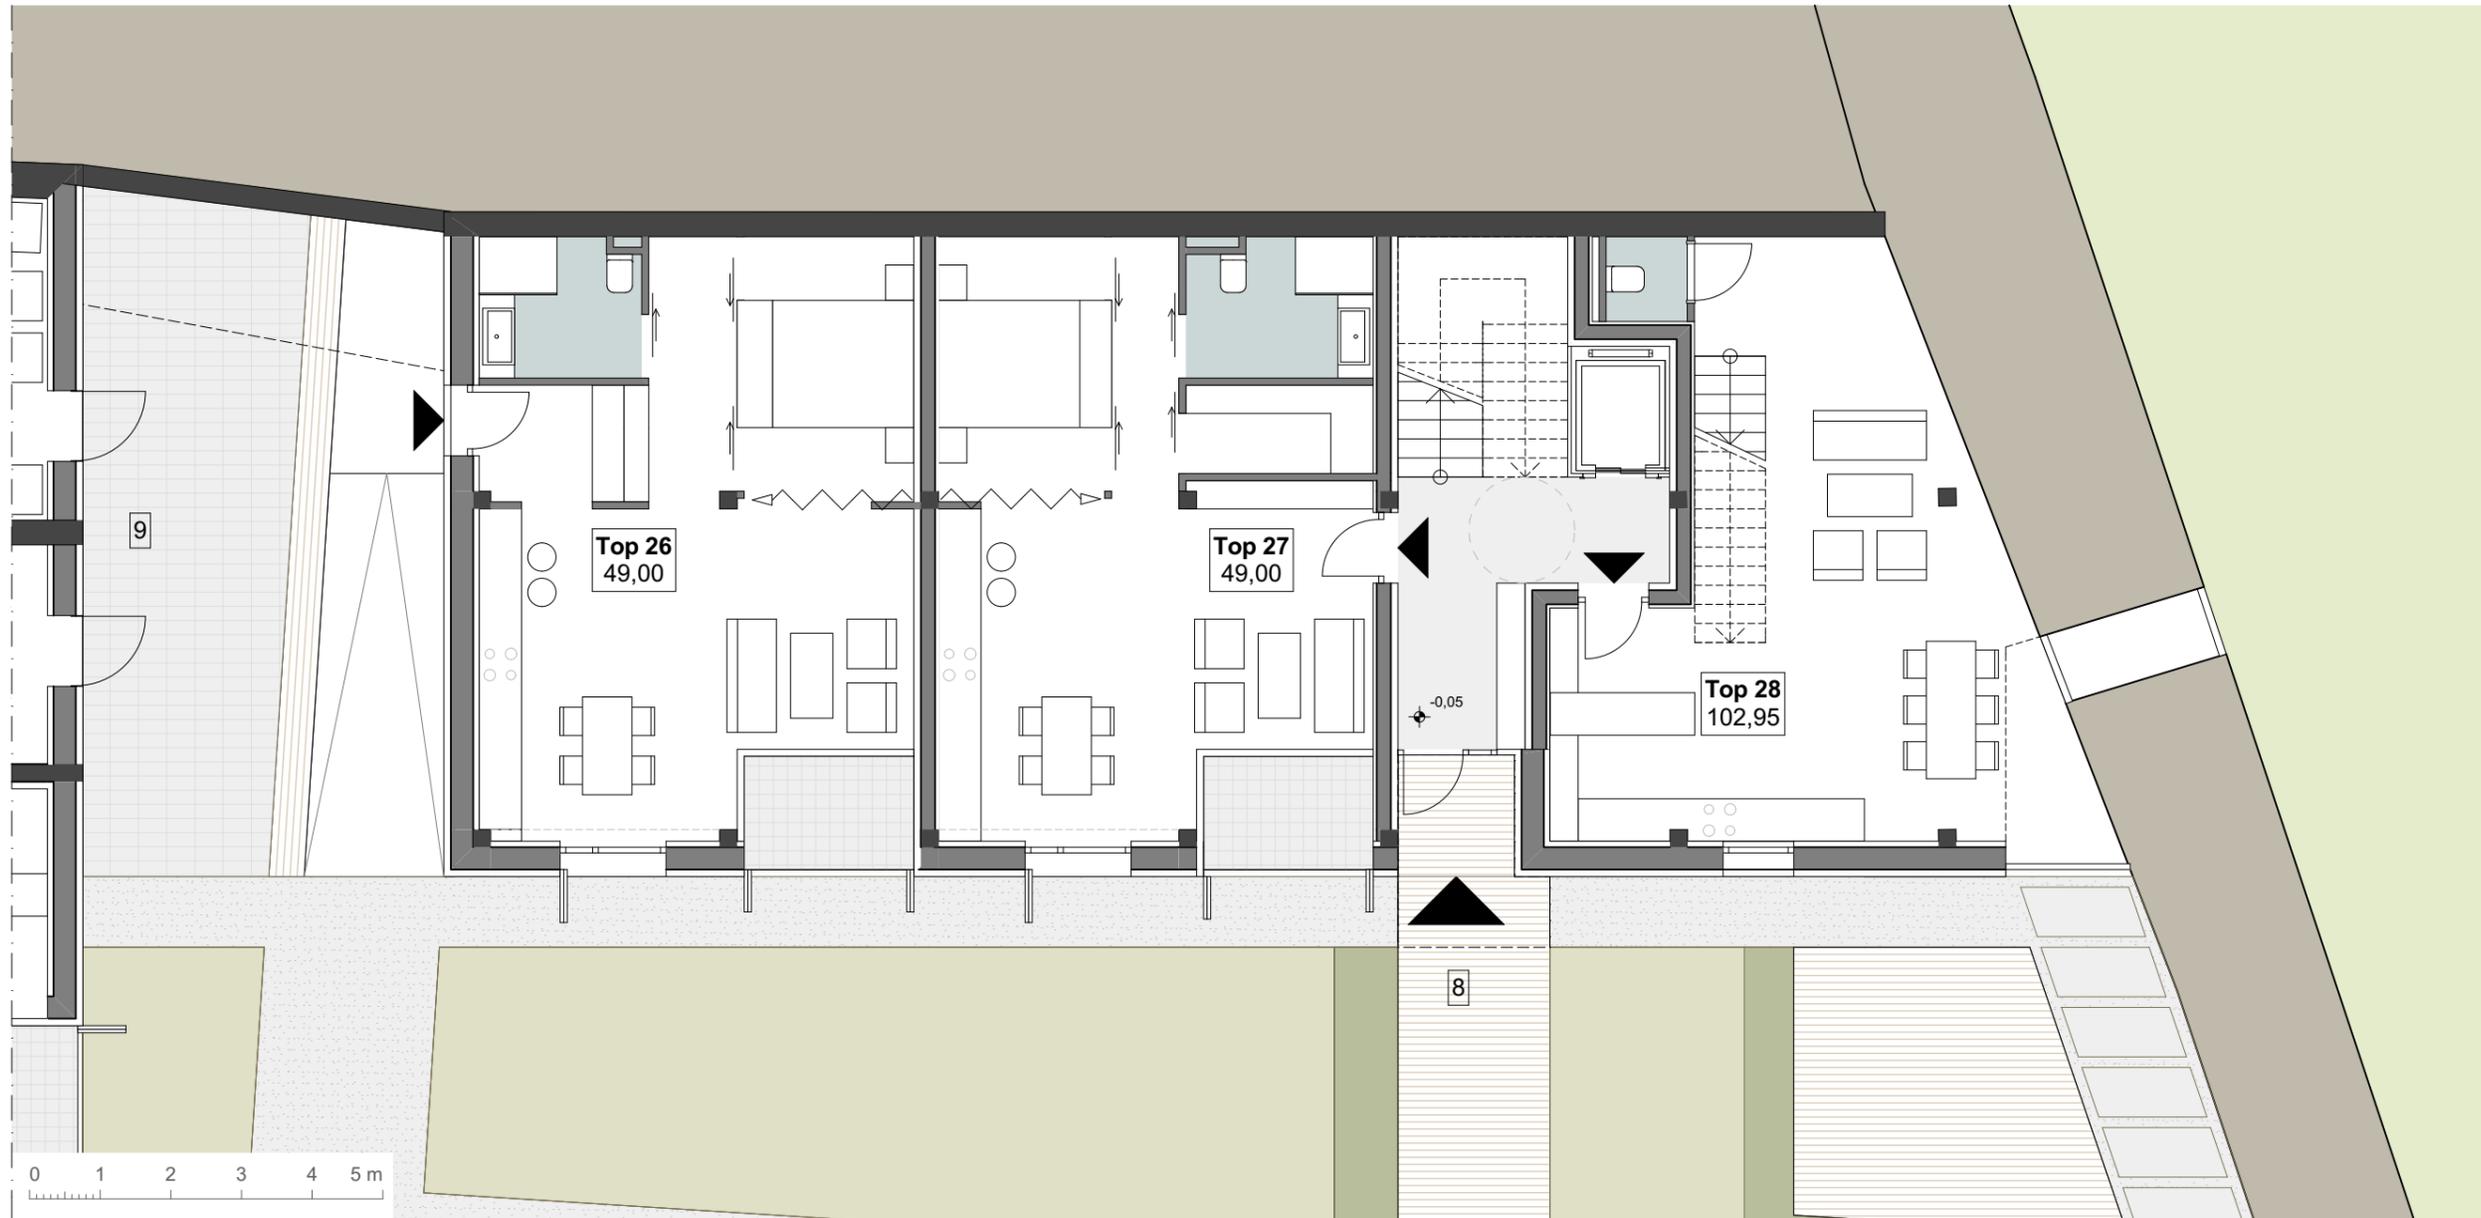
Wohnungstypen Bauteil 3: Erdgeschoss
